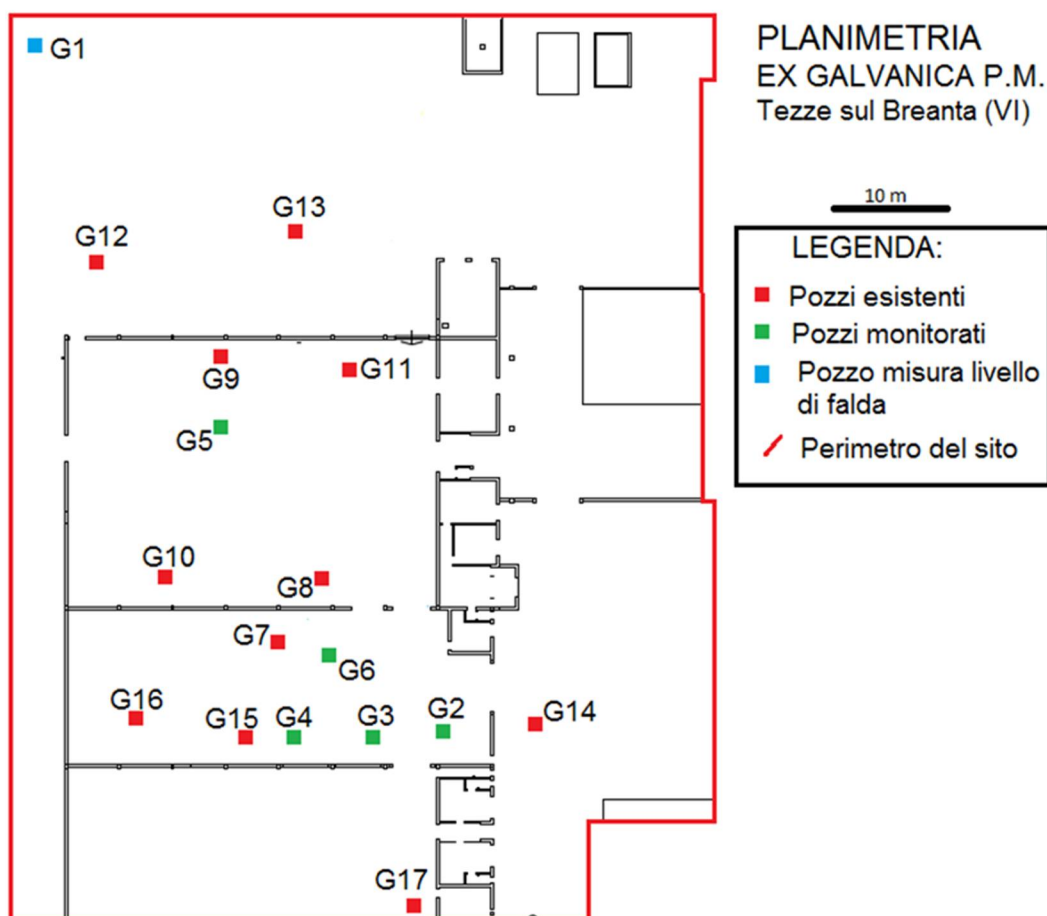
Planimetria area ex Galvanica p.m.. Ubicazione pozzi esistenti
